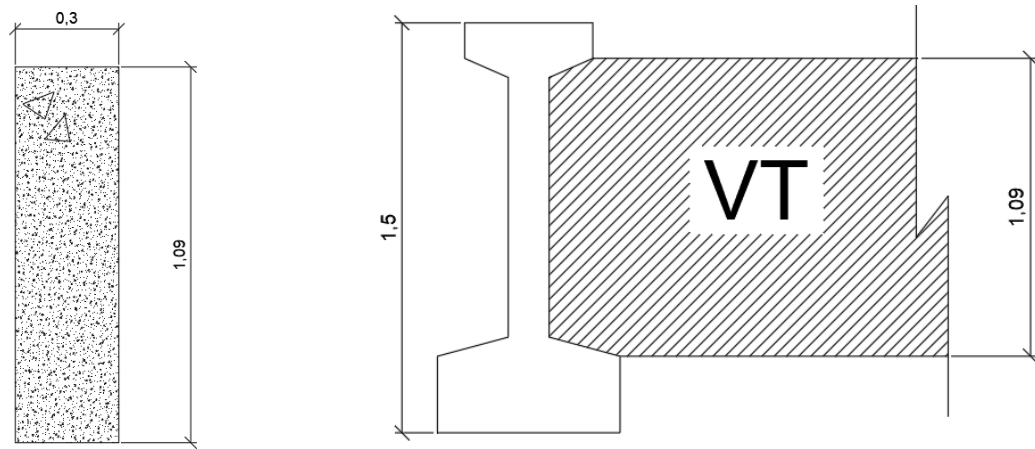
Sección transversal de la viga transversal intermedia
